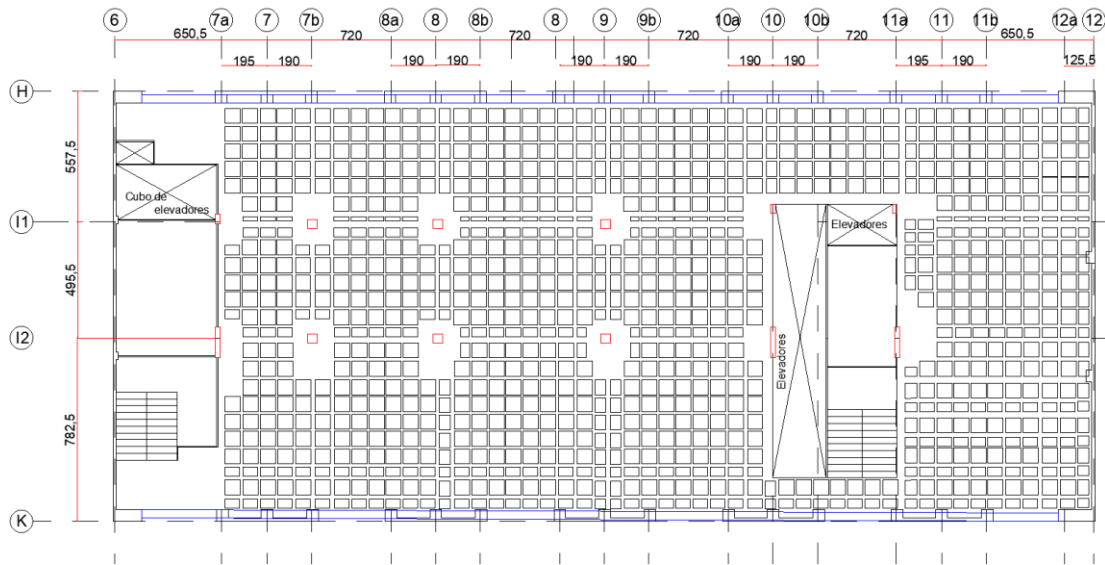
Estructuración de losa nervada, planta baja (adaptado de SRE, 1963).
